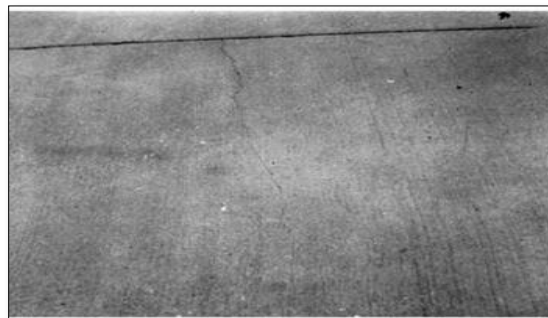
Grietas de retraccion no tiene niveles de severidad definidos.
